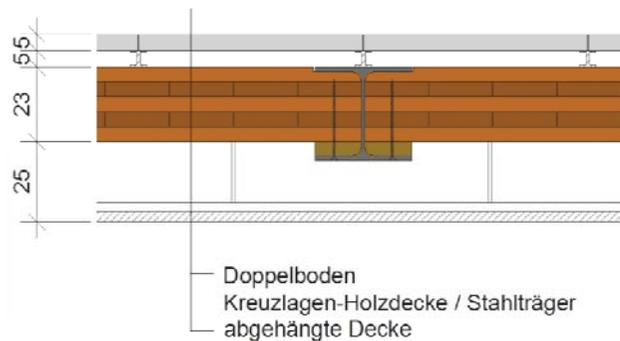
Stahl-Holz-Deckenkonstruktion
